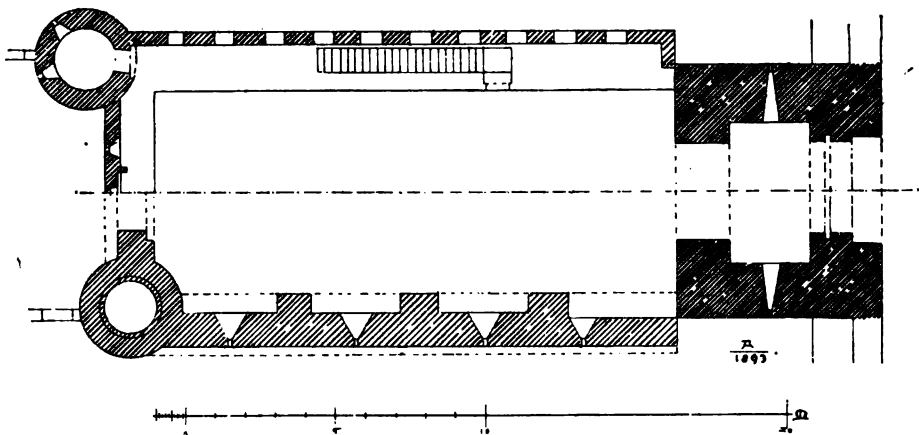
Zülrich. Grundriss des Weierthores.
